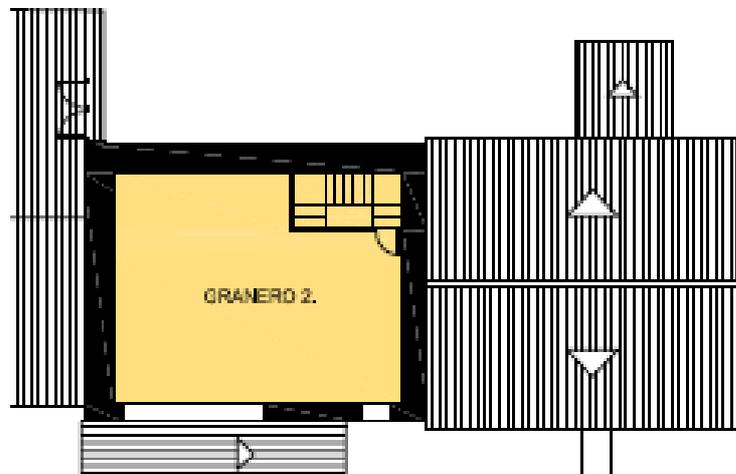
Plano distribución vivienda familiar en Planta Segunda.
